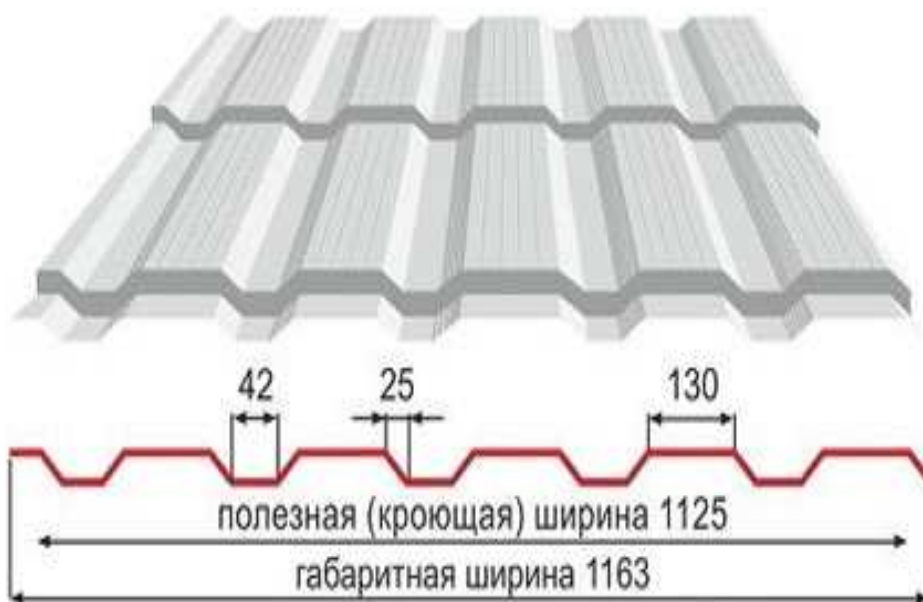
Внешний вид и размеры листа металлочерепицы «Каскад»
